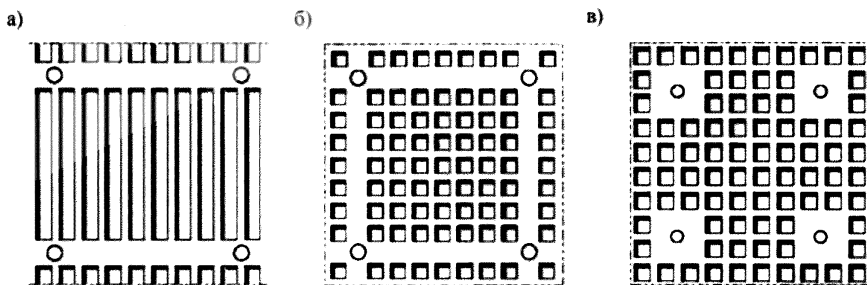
Конструкция ребристых (а) и кессонных плит (б, в) перекрытий
